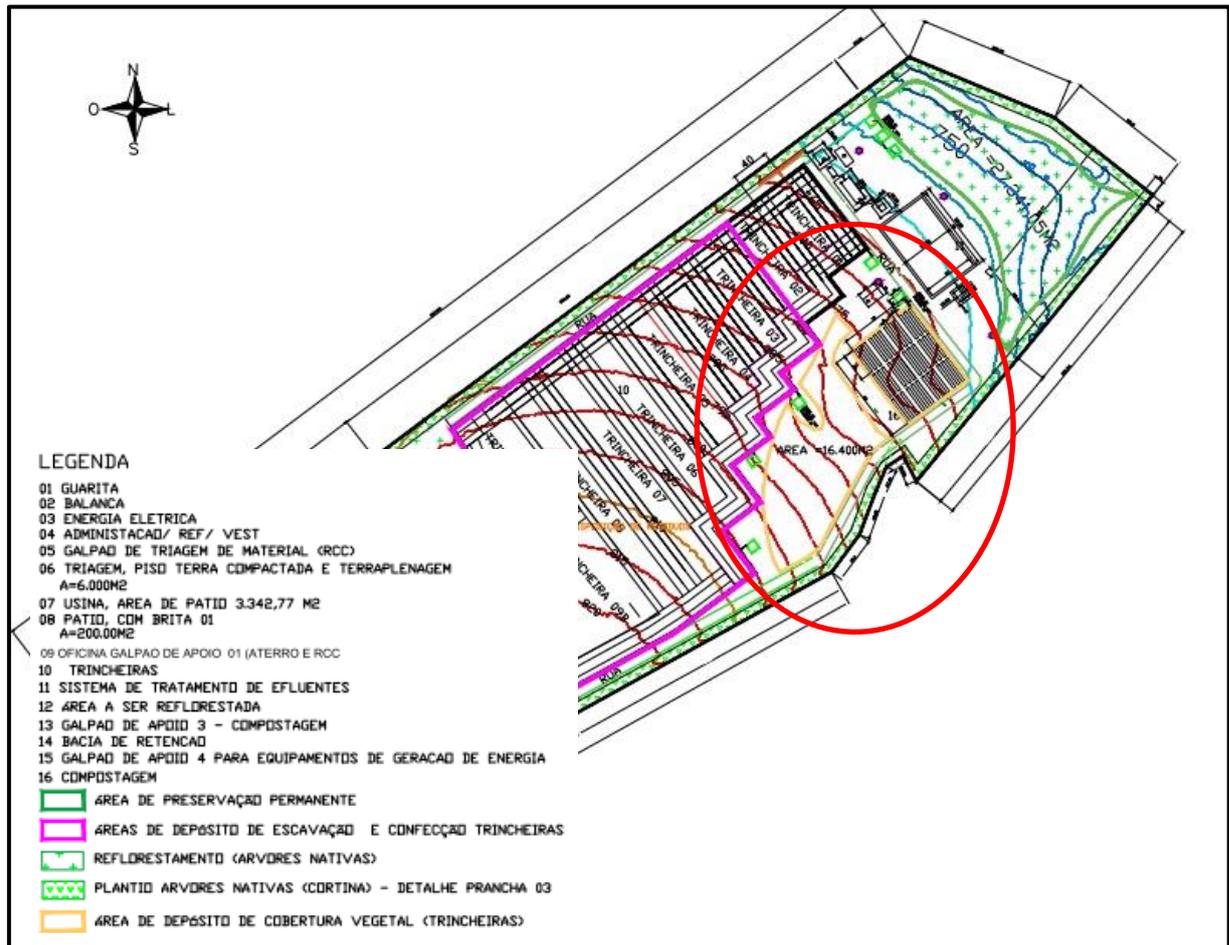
Planta com a disposição da área de depósito de material excedente.
